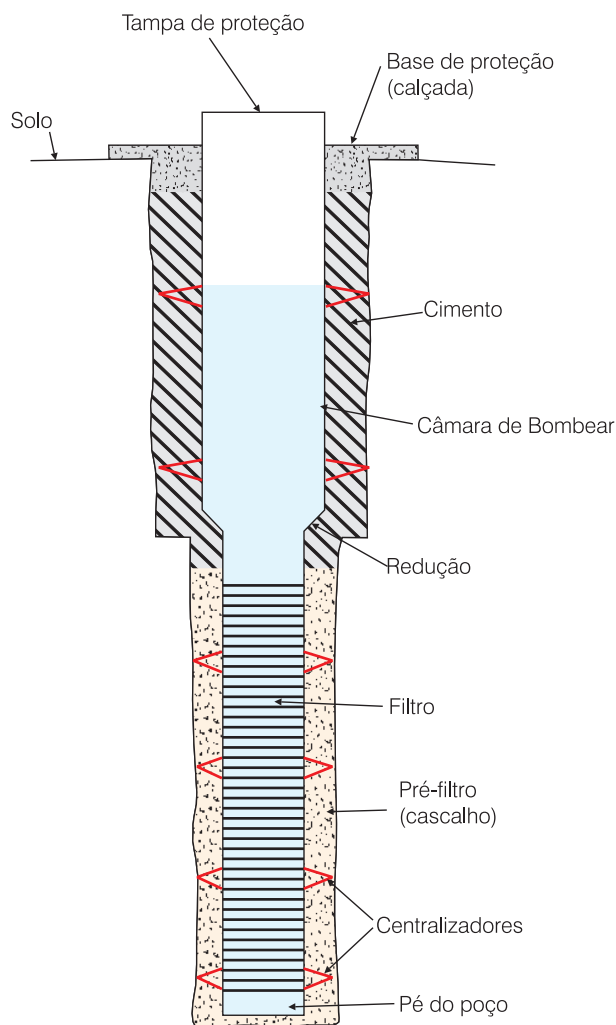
Perfil construtivo esquemático de um poço tubular.
